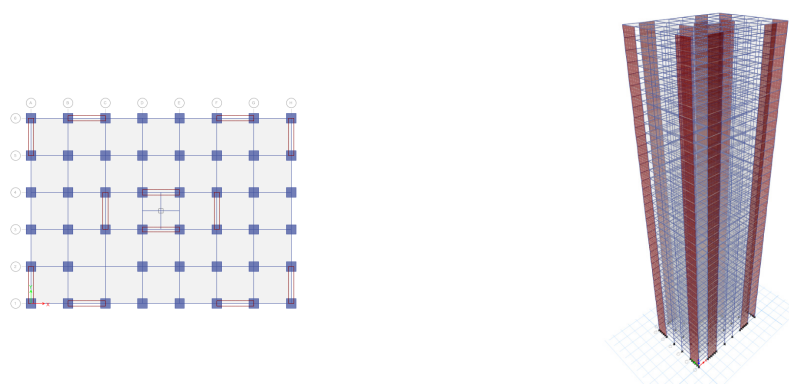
Structura duala din b.a. avand forma dreptunghiulara - plan si elevatie
